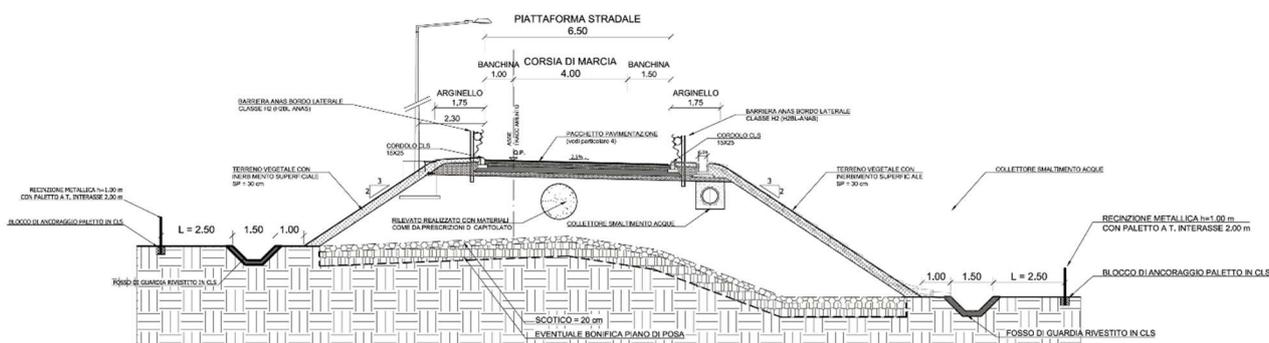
Sezione tipo di rampa monodirezionale in rilevato in rettillo
